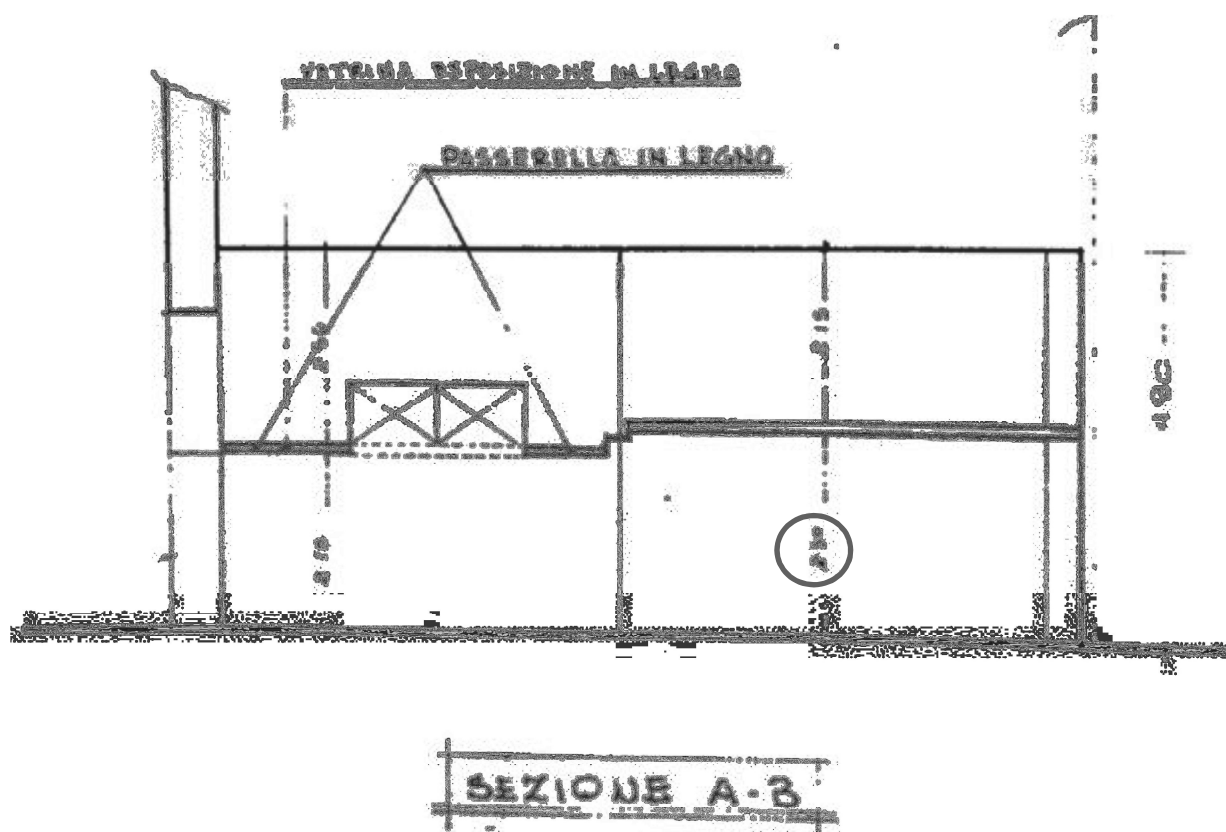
Sezione Concessione Edilizia in Sanatoria 98/2001
